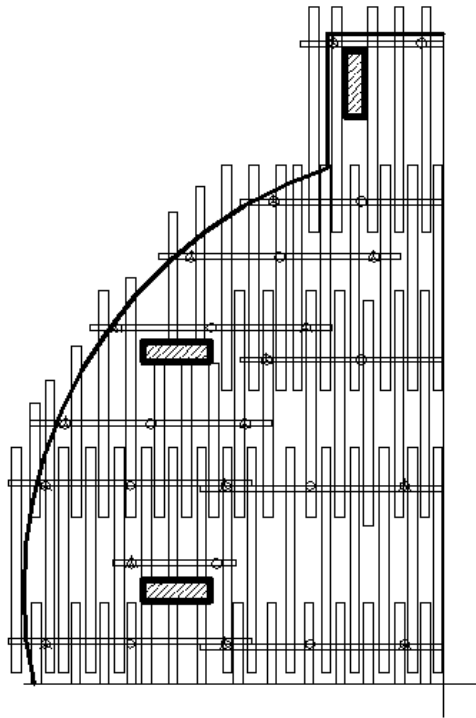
Фрагмент схемы расстановки стоек и раскладки балок опалубки
